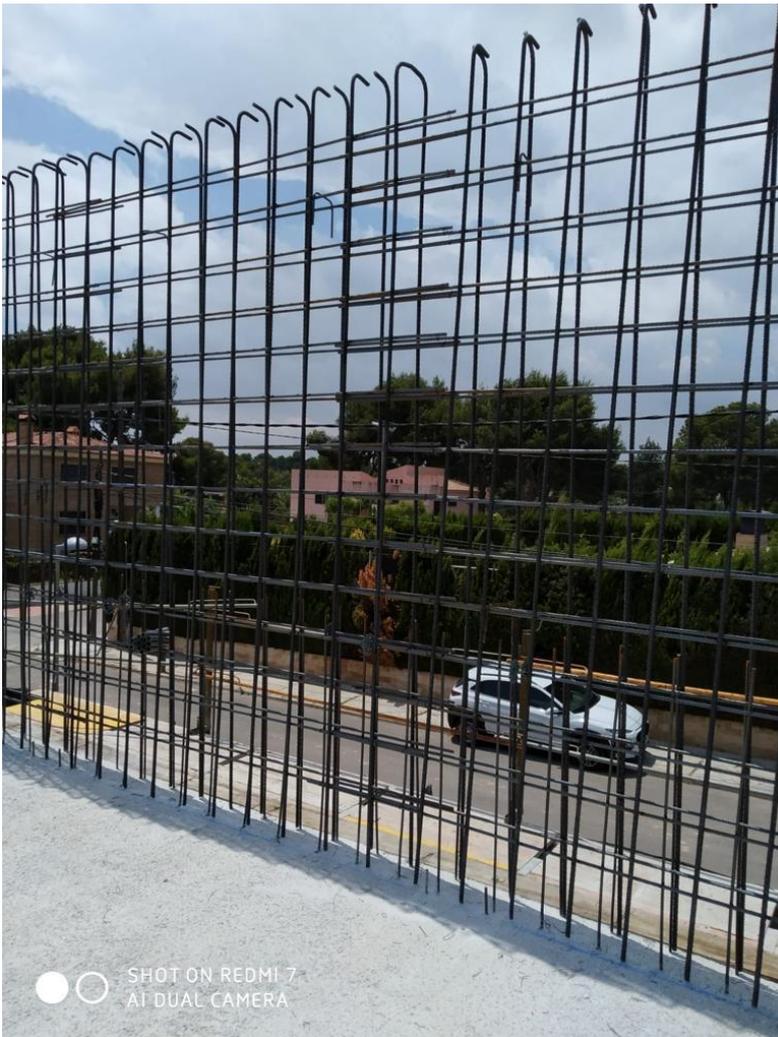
Armado realizado de muros tipo 5 en forjado a +4,08. 2020. Fuente propia
